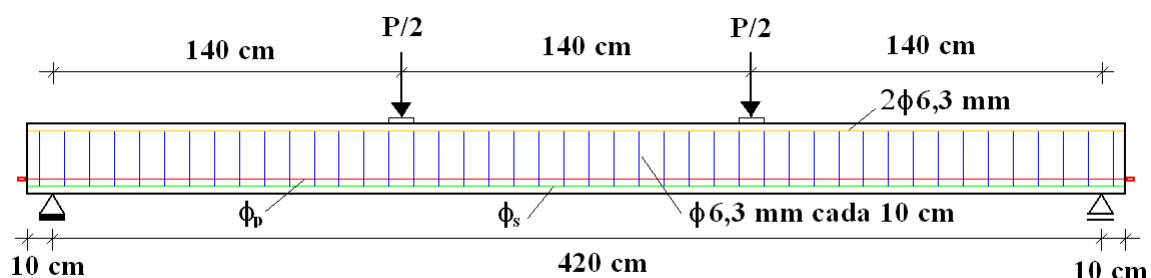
Detalhamento das vigas de Du e Tao (1988)
